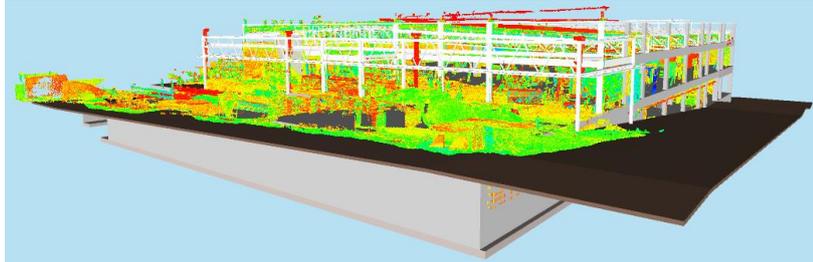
NP da cobertura metálica sobreposta ao modelo 3D.
